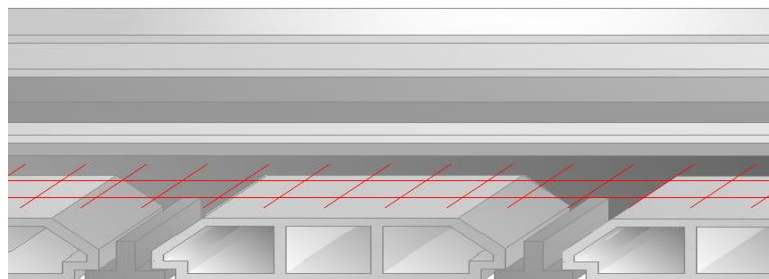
Coupe verticale du plancher terrasse à corps creux.
